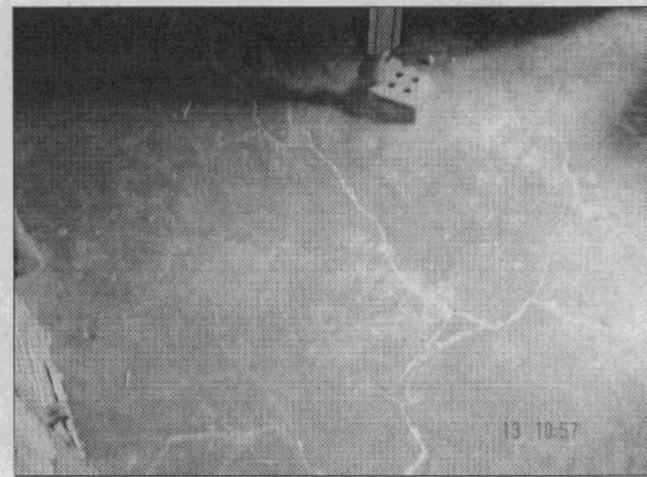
Fisura en la junta del muro de patio con la vivienda.
